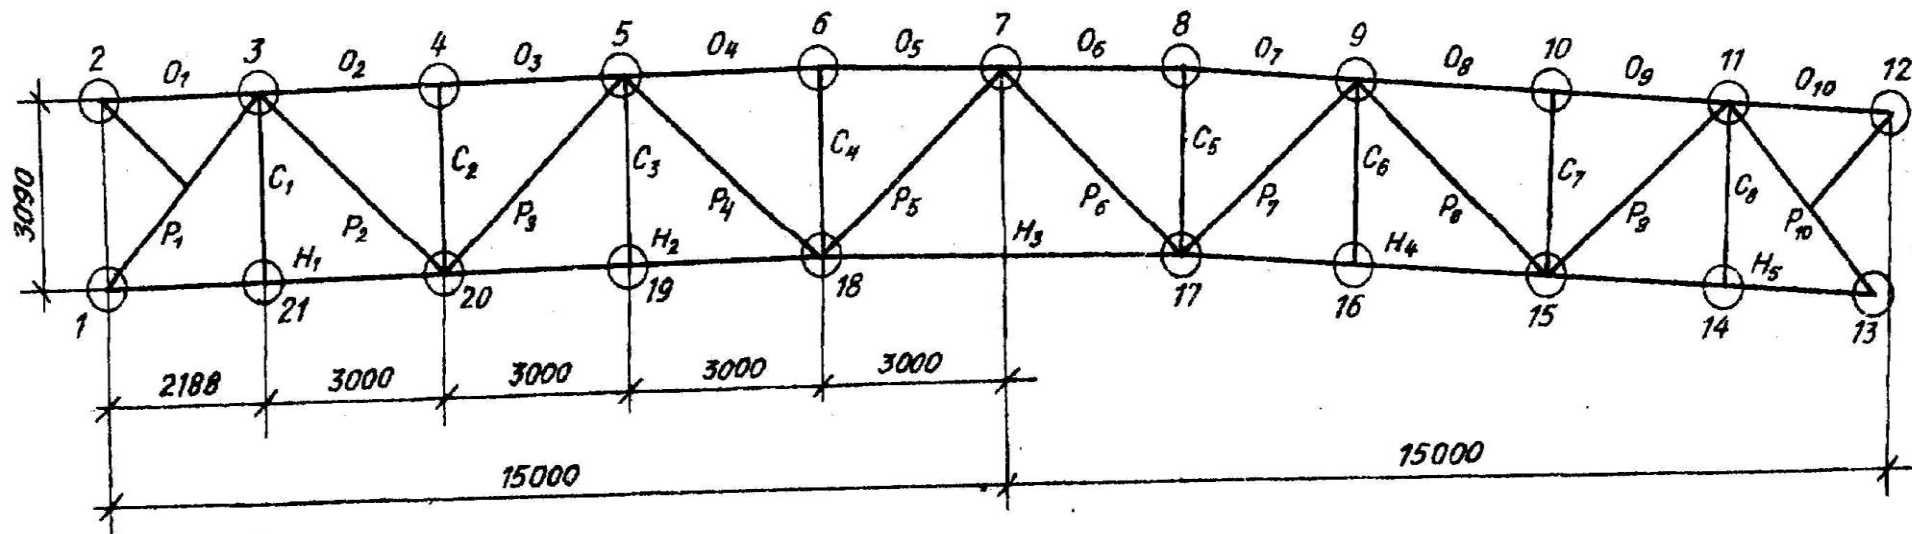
Геометрическая схема фермы ФС 30 – 1,5 0В; 1,50 D1
